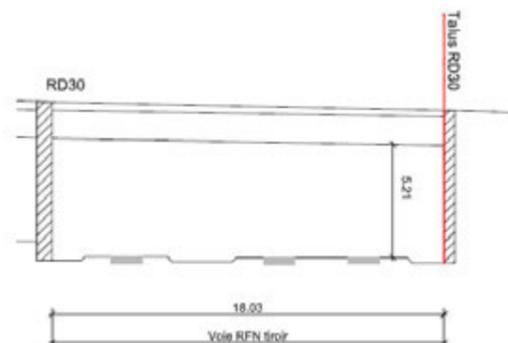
Coupe de l'existant sous l'ouvrage de la RD30
